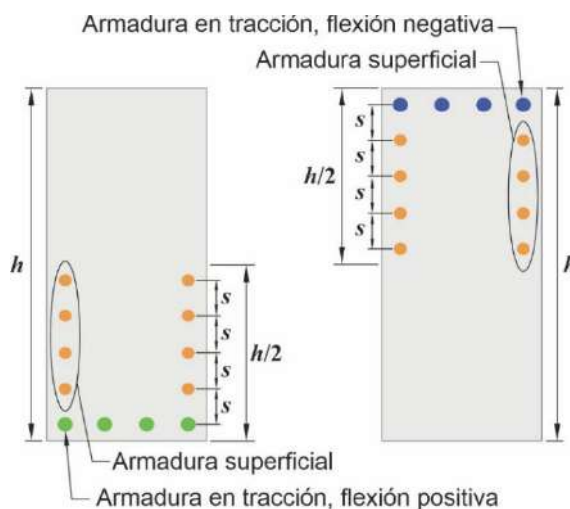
Armadura superficial para vigas y viguetas con $h > 900$ mm
